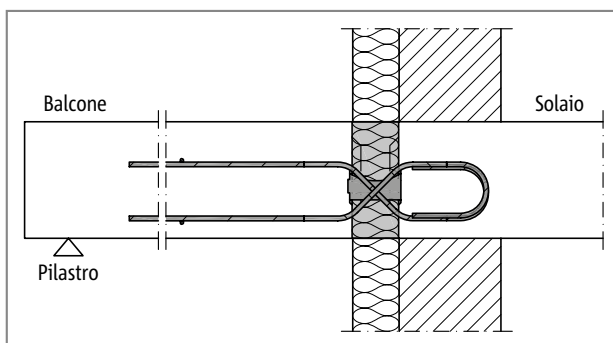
Schöck Isokorb® tipo Q-VV: raccordo con sistema di isolamento a cappotto
